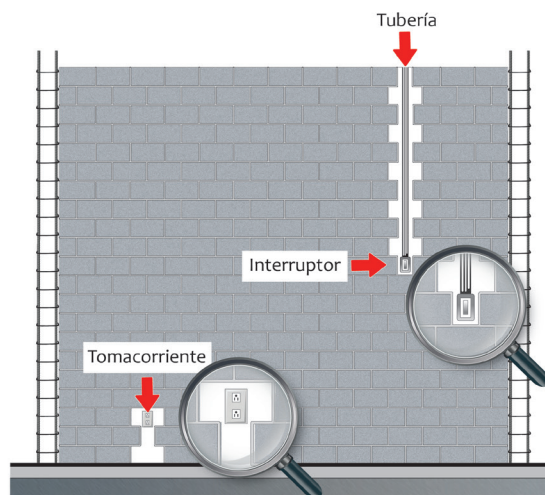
Conexiones eléctricas en el muro en columnetas
